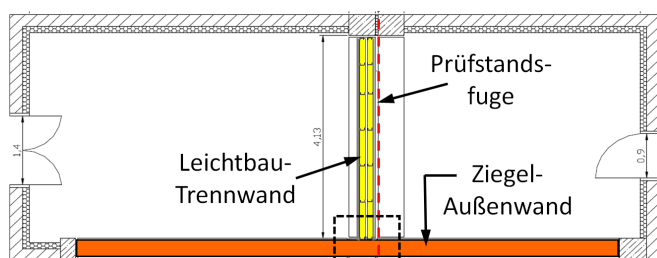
Grundrisssskizze Prüfaufbau im Flankenprüfstand der HFT Stuttgart.
